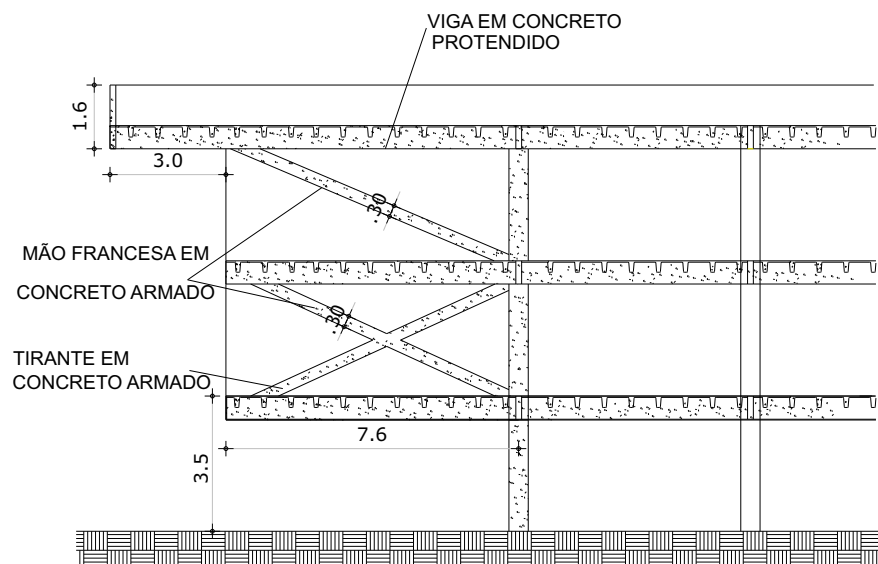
Detalhe estrutural da fachada sudoeste-sem escada.
